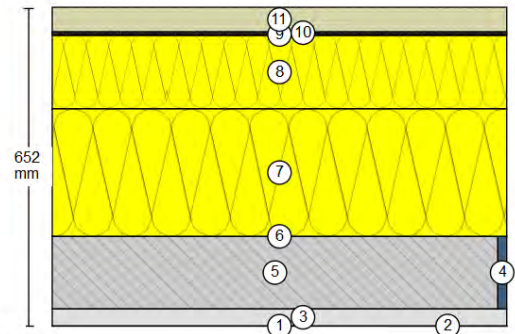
Bauteil, Dachbeläge, Decke Bestand_30cm_7cm
